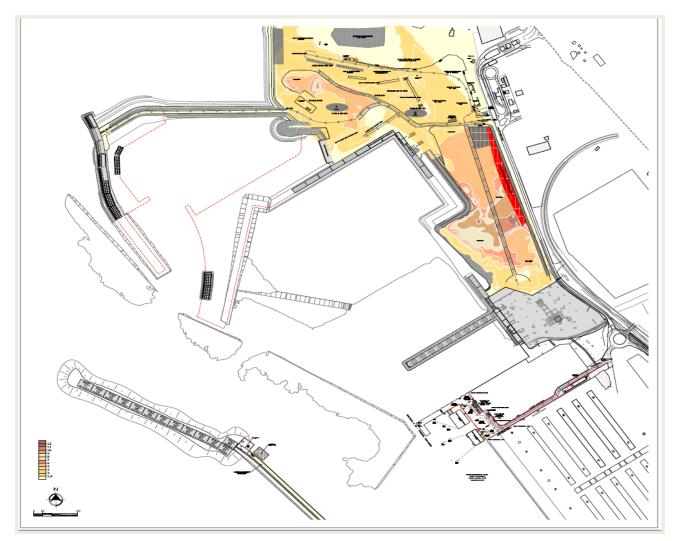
Porto di Civitavecchia - Opere Strategiche - Planimetria della situazione attuale
